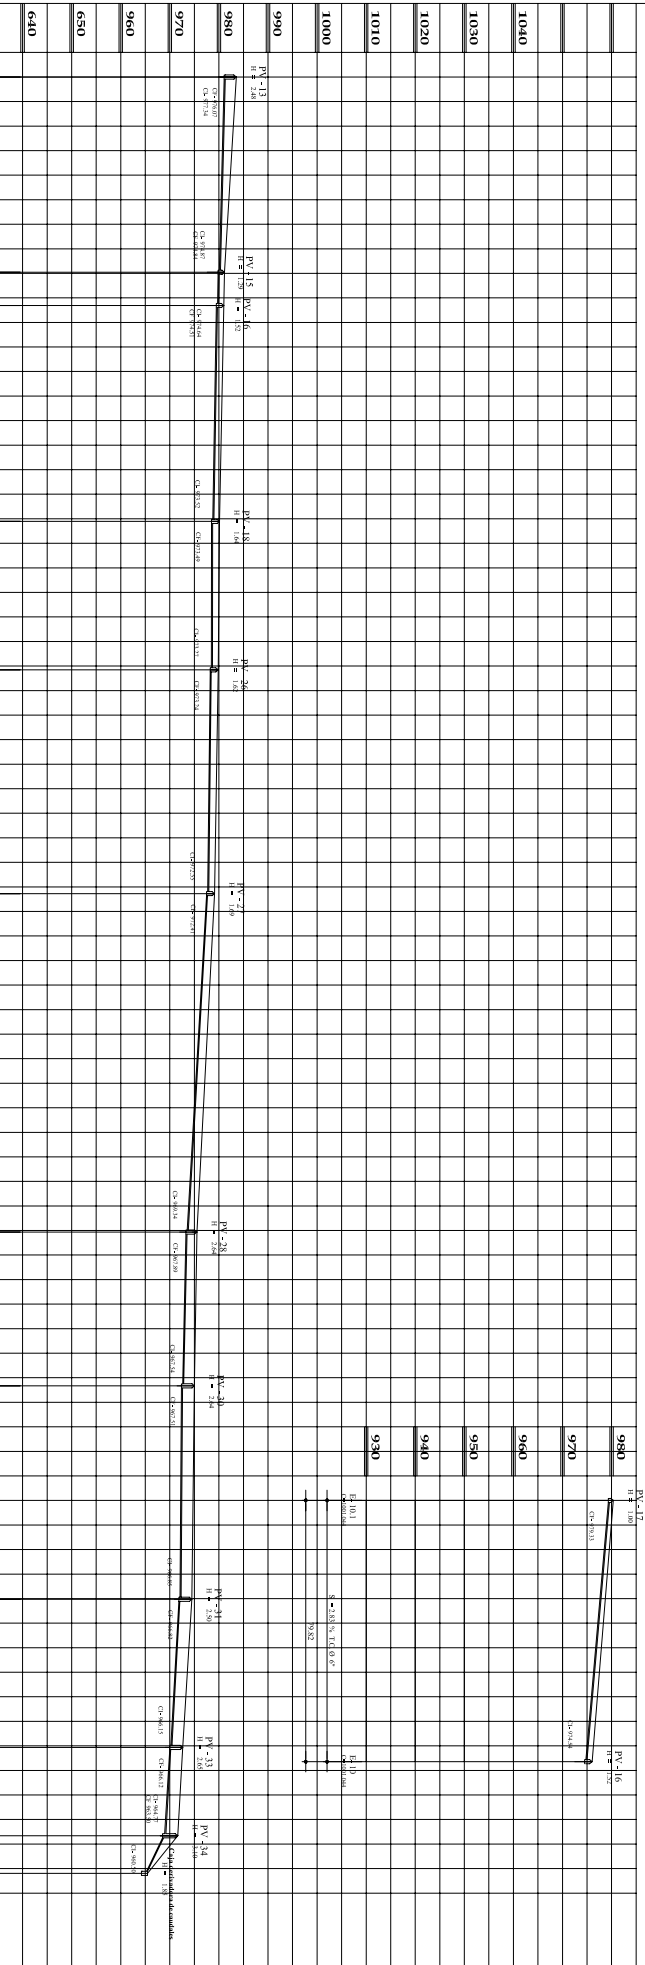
Planta, perfil alcantarillado sanitario Aldea El Chagüite
